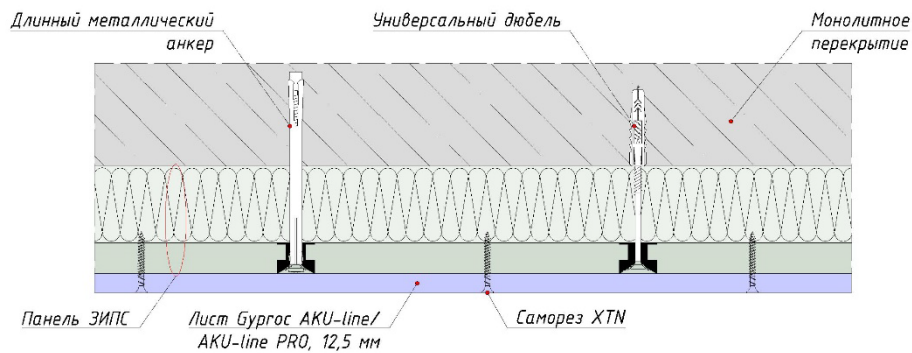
Монтаж панельной системы ЗИПС на монолитное перекрытие.
